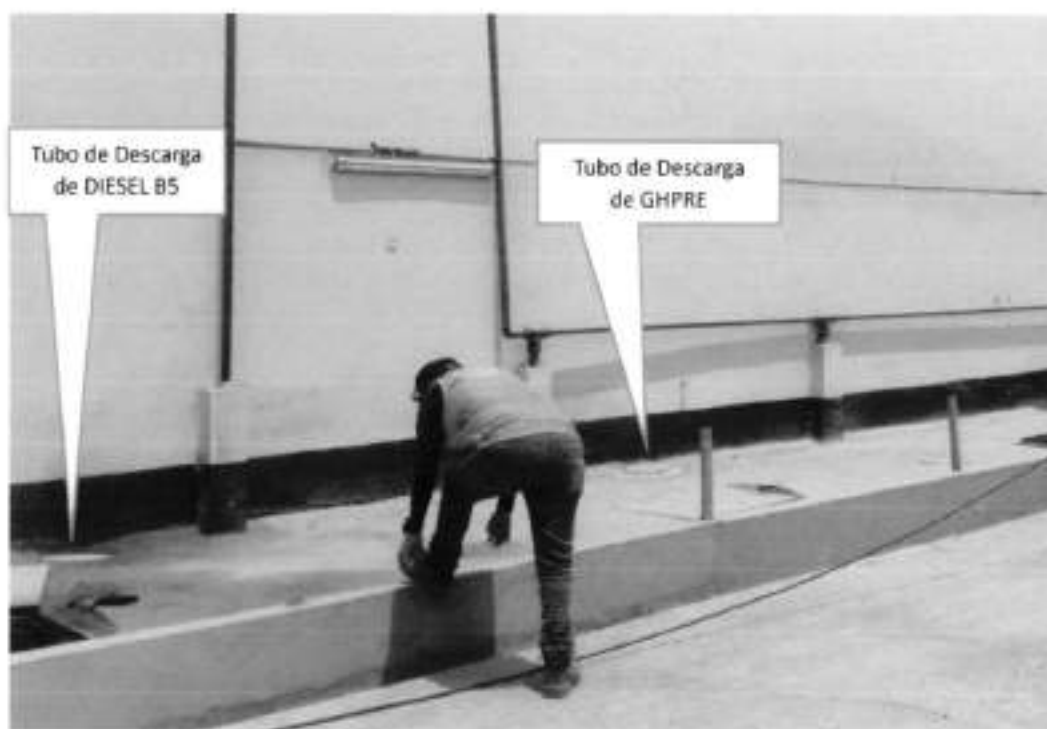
Vista tanque N° 1 y 2; Se verifica las tuberías de descarga distinta a lo aprobado en el EIA (No se encuentran en una zona todas las tuberías descarga y venteo).
